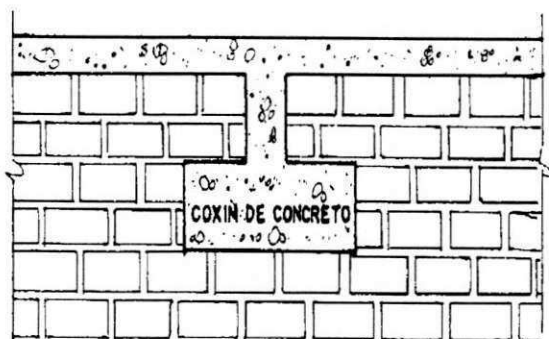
Coxim de Concreto na Alvenaria de Tijolos
